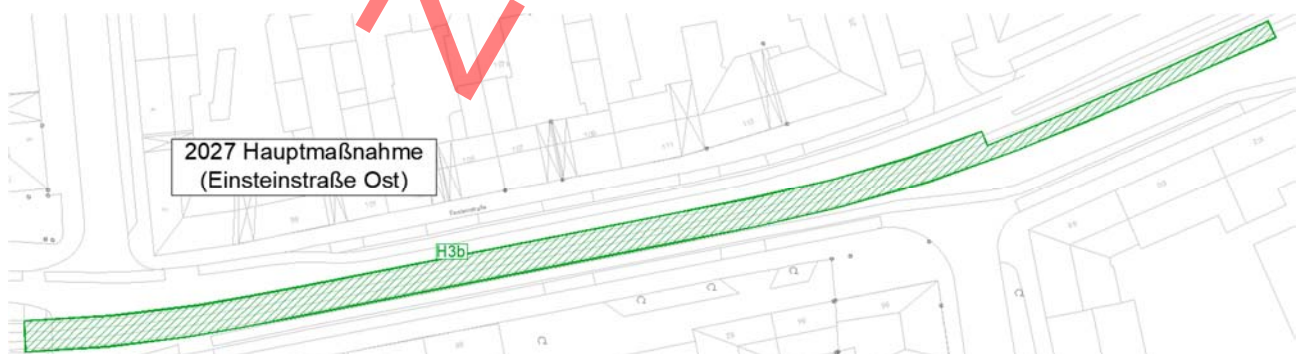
Tramgleissanierung in der Einsteinstraße zw. Flurstraße und Grillparzerstraße
